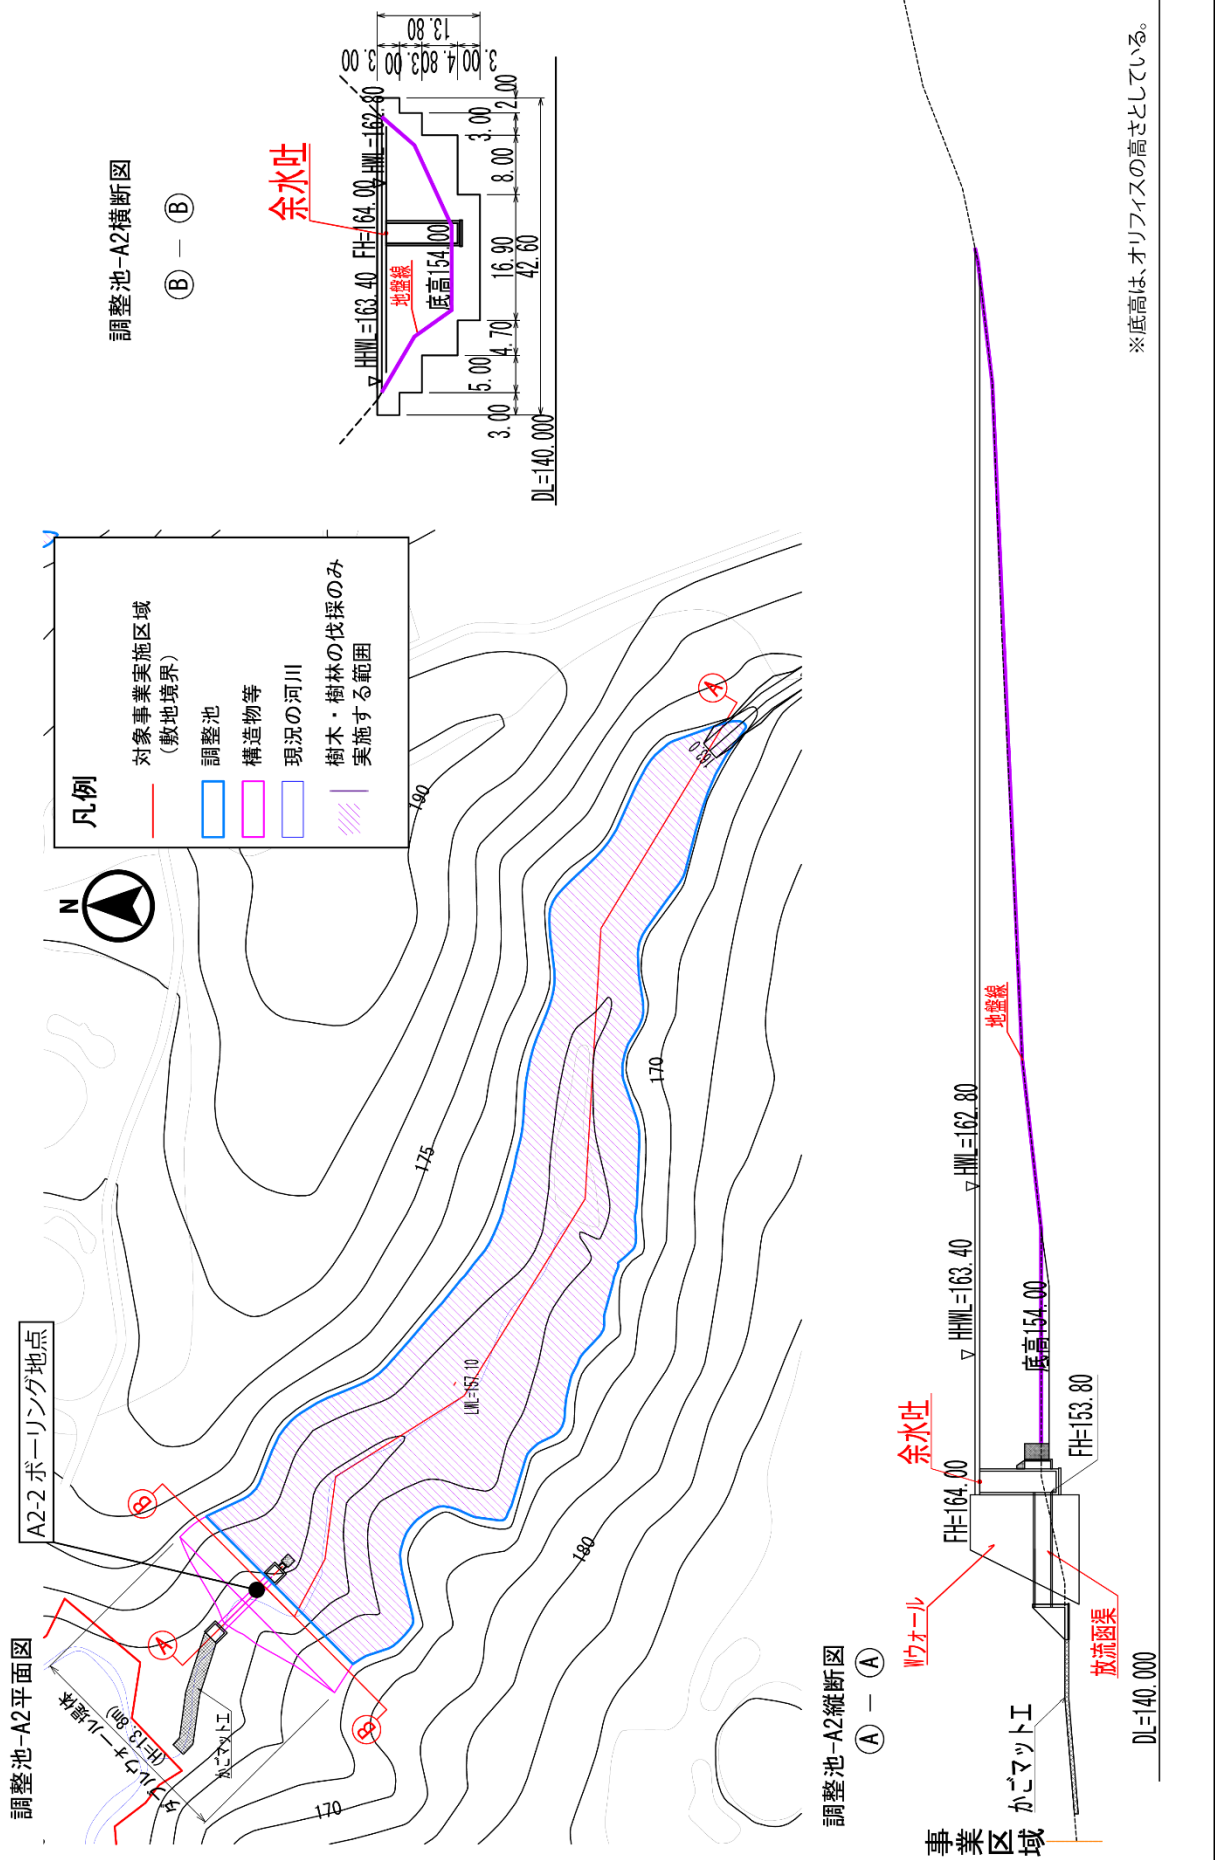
(2) 調整池の平面図・断面図 (A2)
